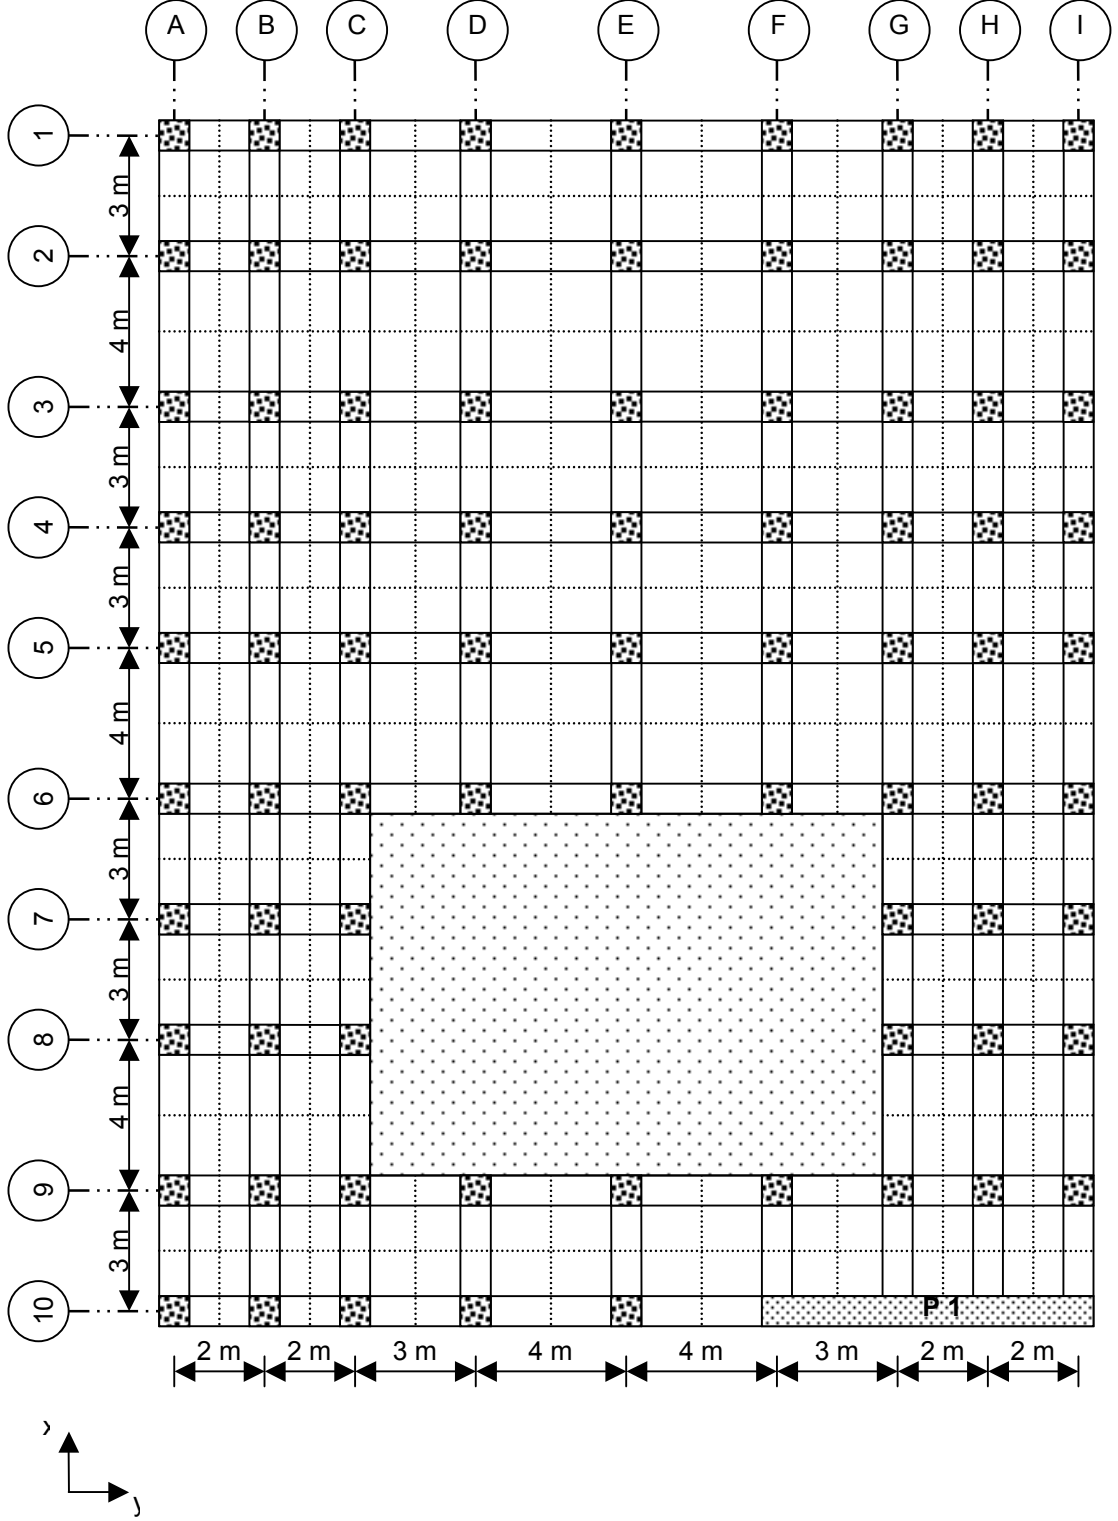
Örnek 5.8'in kat kalıp planı
